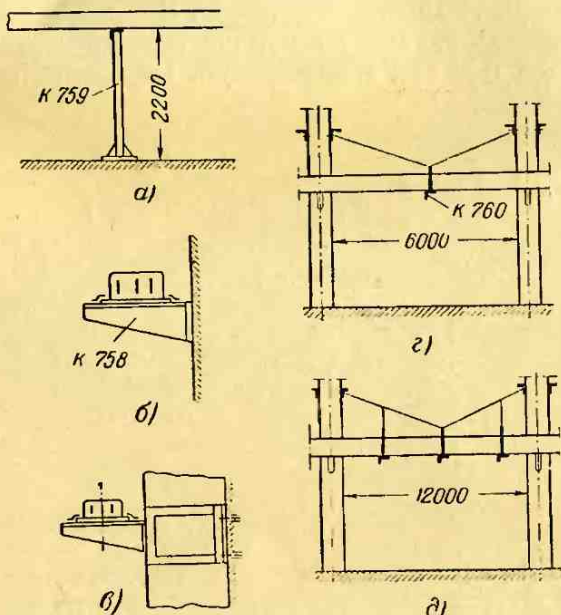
Установка шинопроводов серии ШРА-60 на опорных конструкциях.
